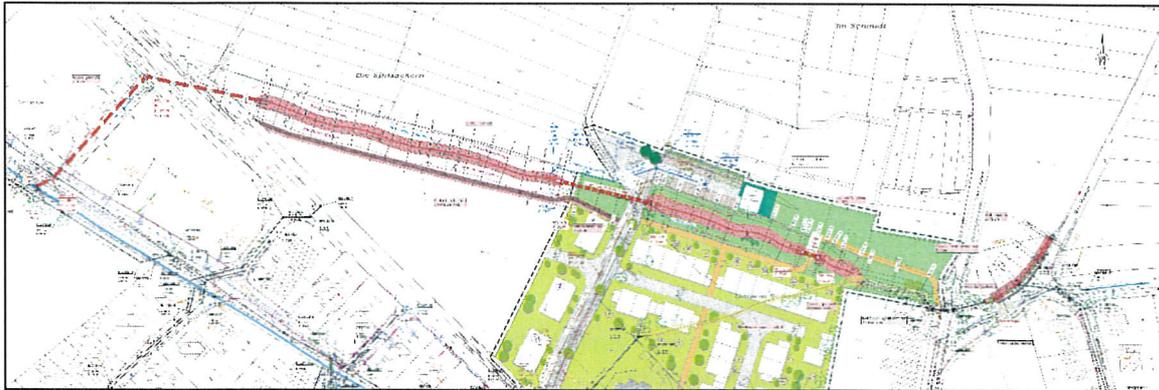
Lageplan Planung Verlegung Eisbrunnengraben; Quelle: Zink Ingenieure, 30.11.2020
